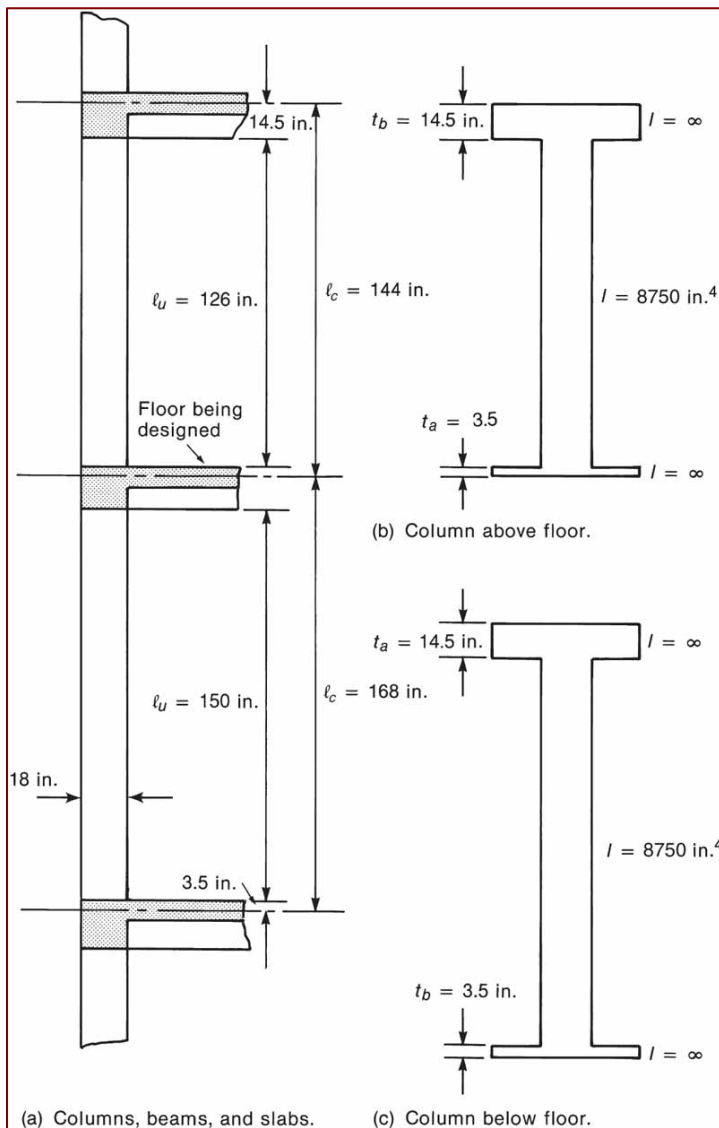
Columnas exteriores de la junta de losa en B1 para ejemplo 10-8.
